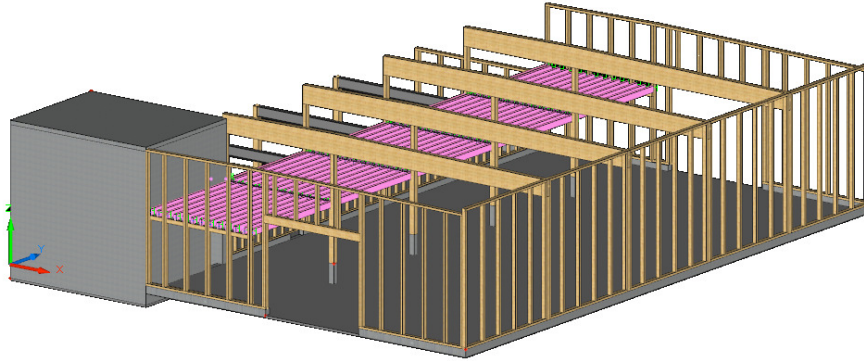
Gewerbegebäude Schwarz Gerüstbau Signau
